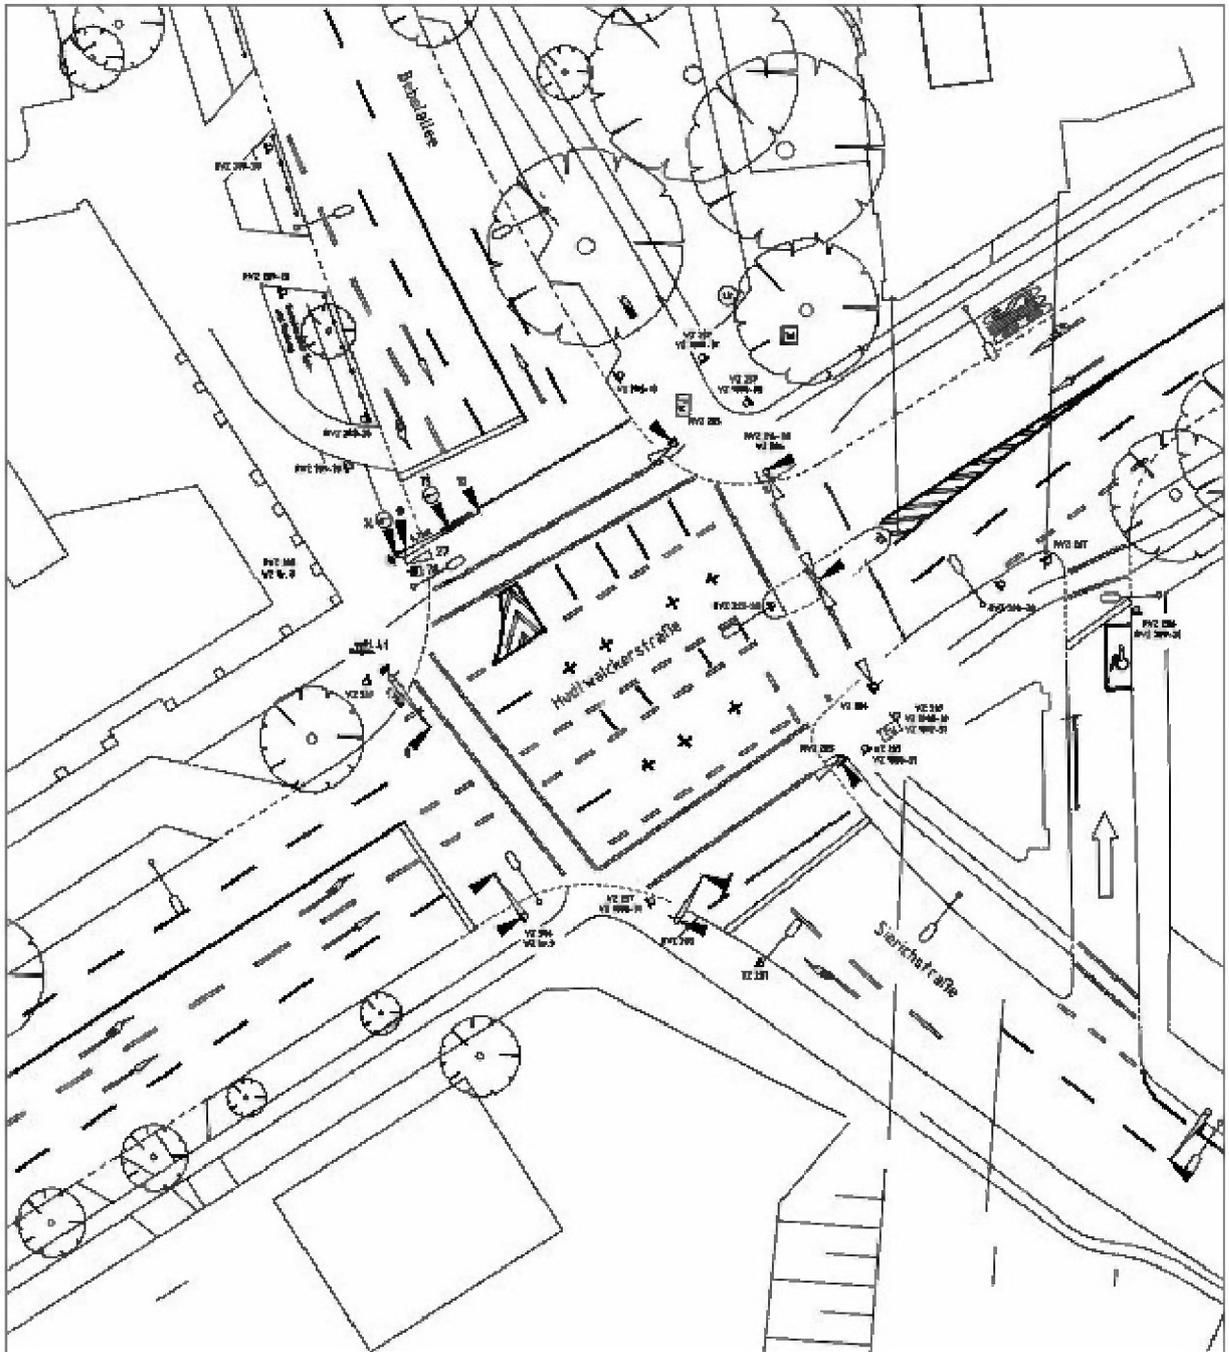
3 Signallageplanausschnitt LSA 55
